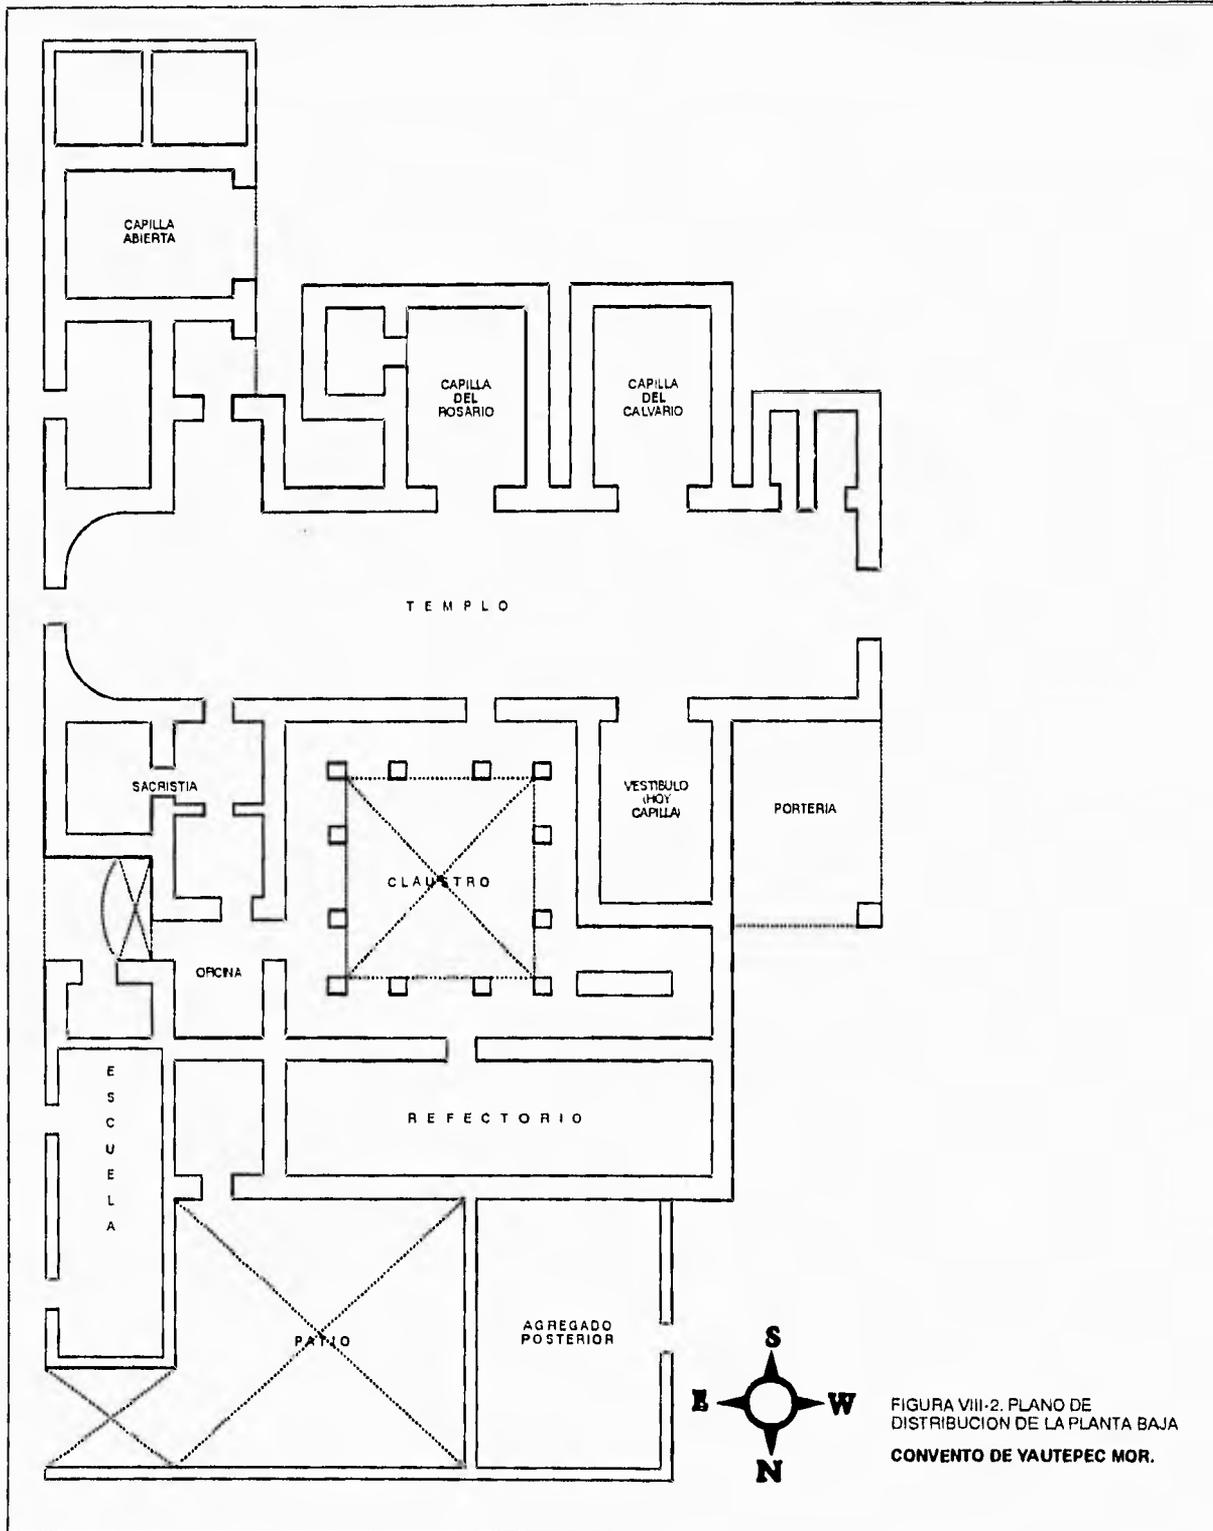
PLANO DE DISTRIBUCION DE LA PLANTA BAJA CONVENTO DE YAUTEPEC MOR.
